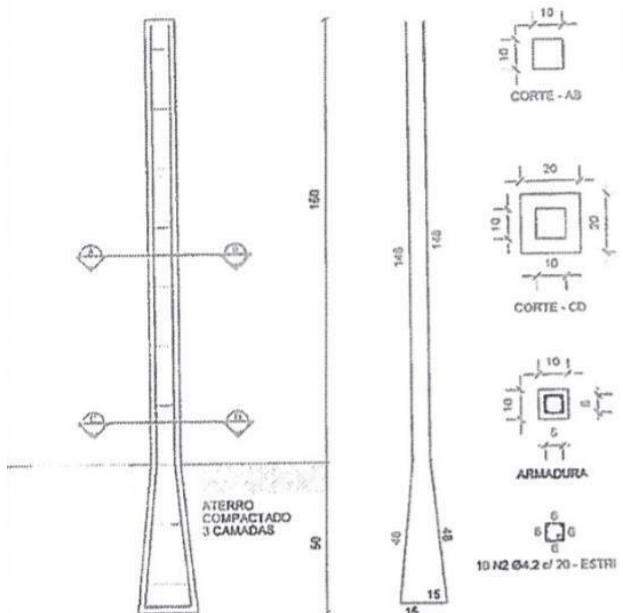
Exemplo de estaca testemunha de concreto a ser adotado em área rural.
